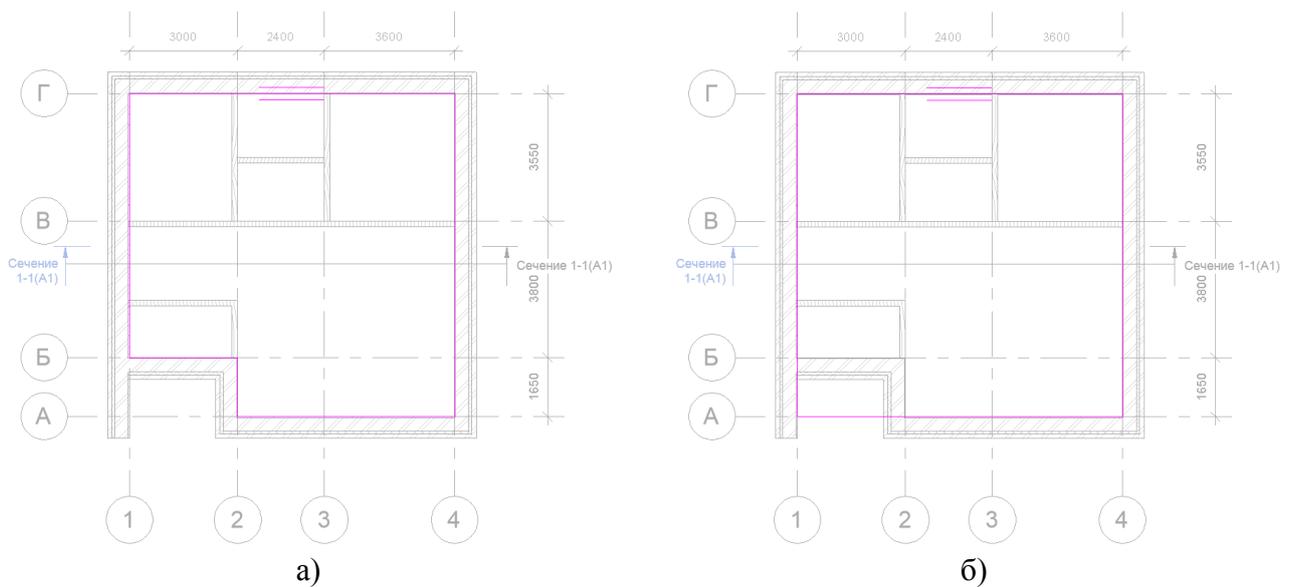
Эскиз: а) пола первого этажа, б) перекрытия между первым и вторым этажами
